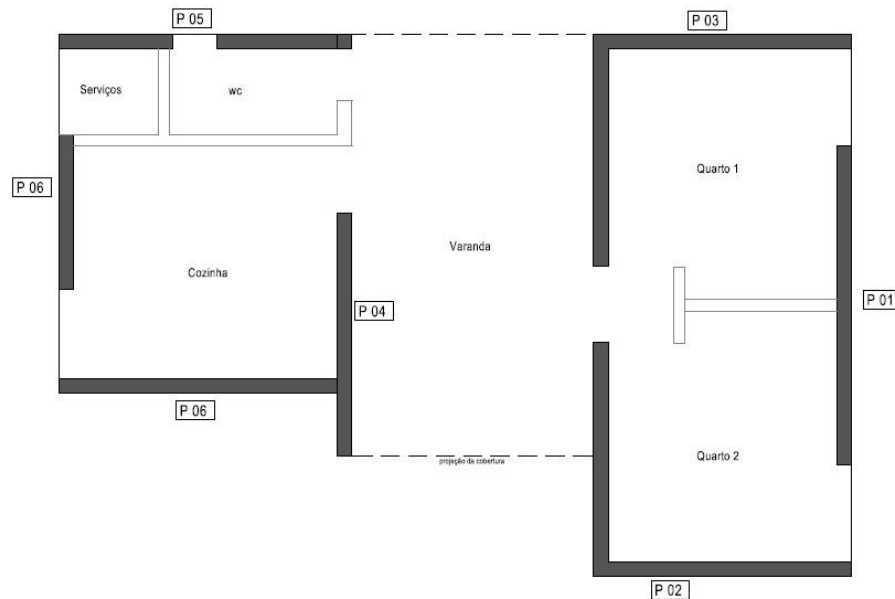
Planta baixa do projeto com a ordem de execução das paredes.
